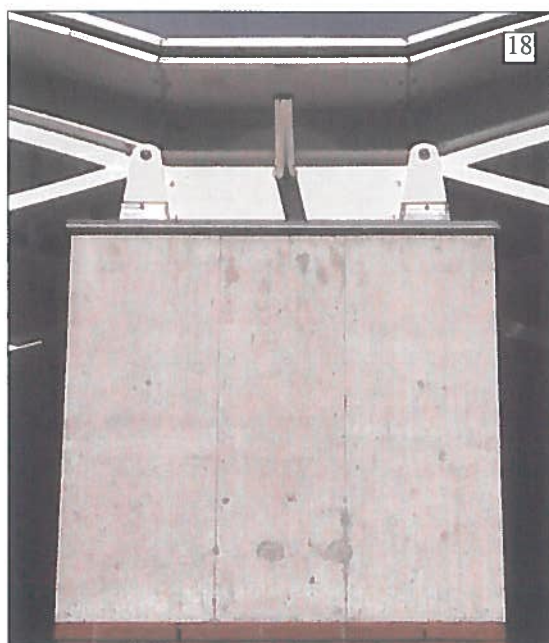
Centro sportivo, Tenero. Dettaglio degli appoggi delle travi a fuso sulla trave in cemento armato.
